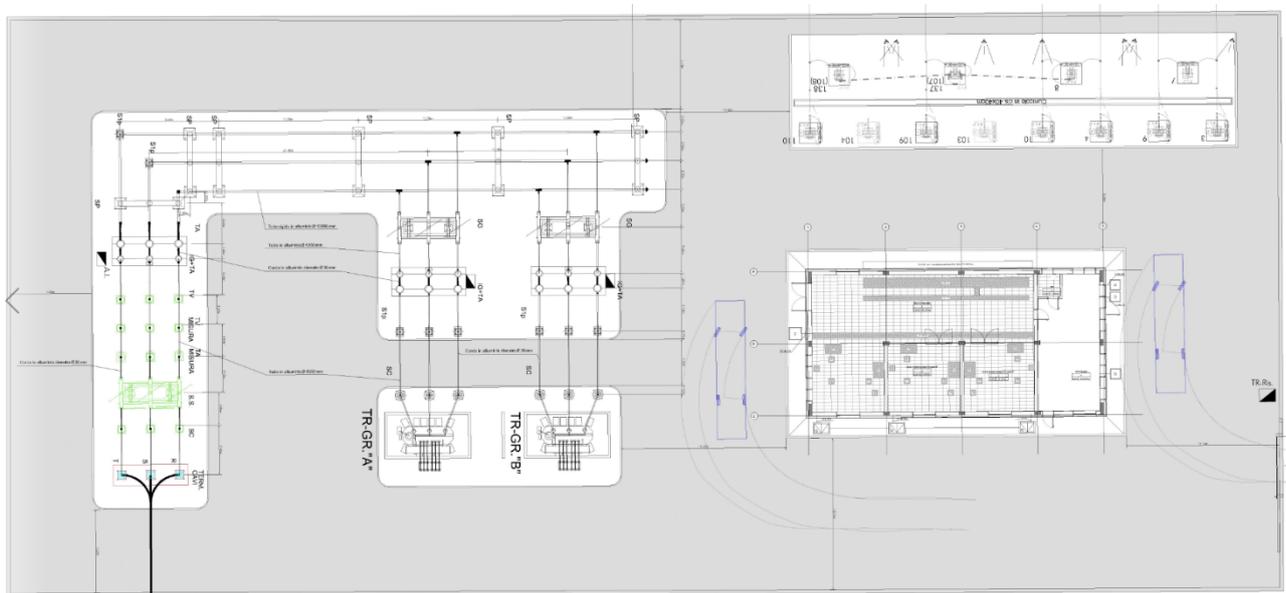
SSE Pieve Emanuele -Planimetria di progetto
